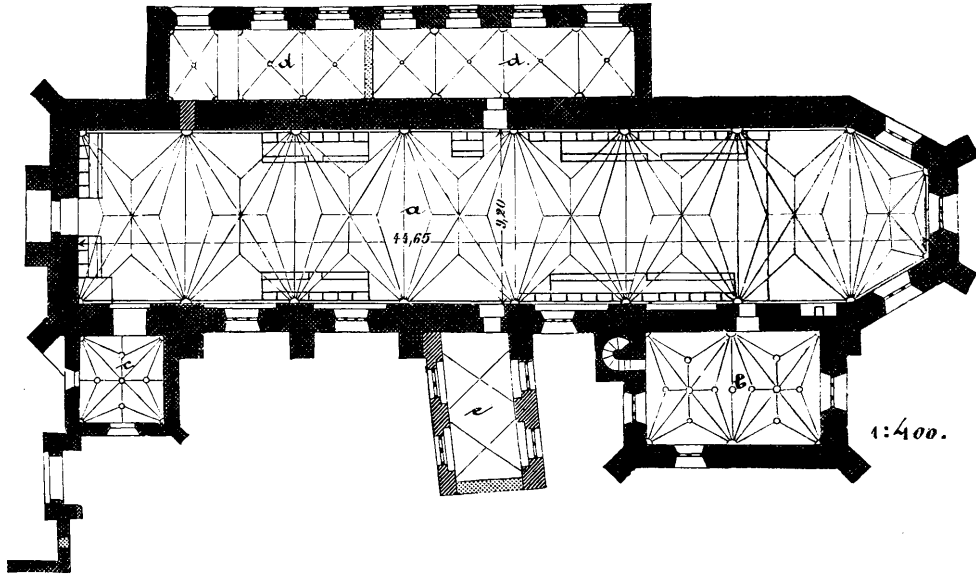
Carthaus. Grundriss der Klosterkirche.
